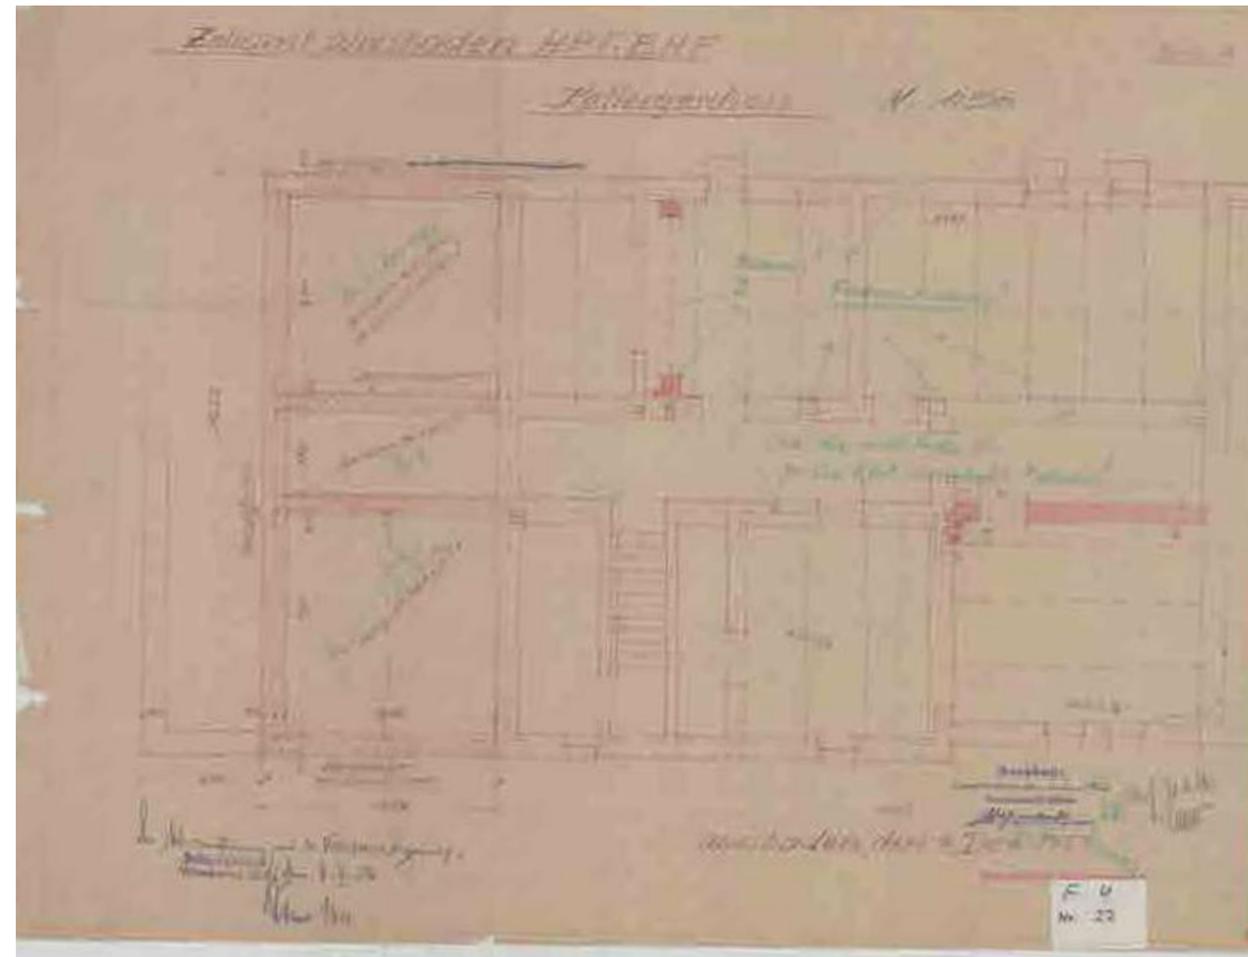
Zollabfertigung: Plan mit Grundriss des Kellergeschosses für den Wiederaufbau, 1951
